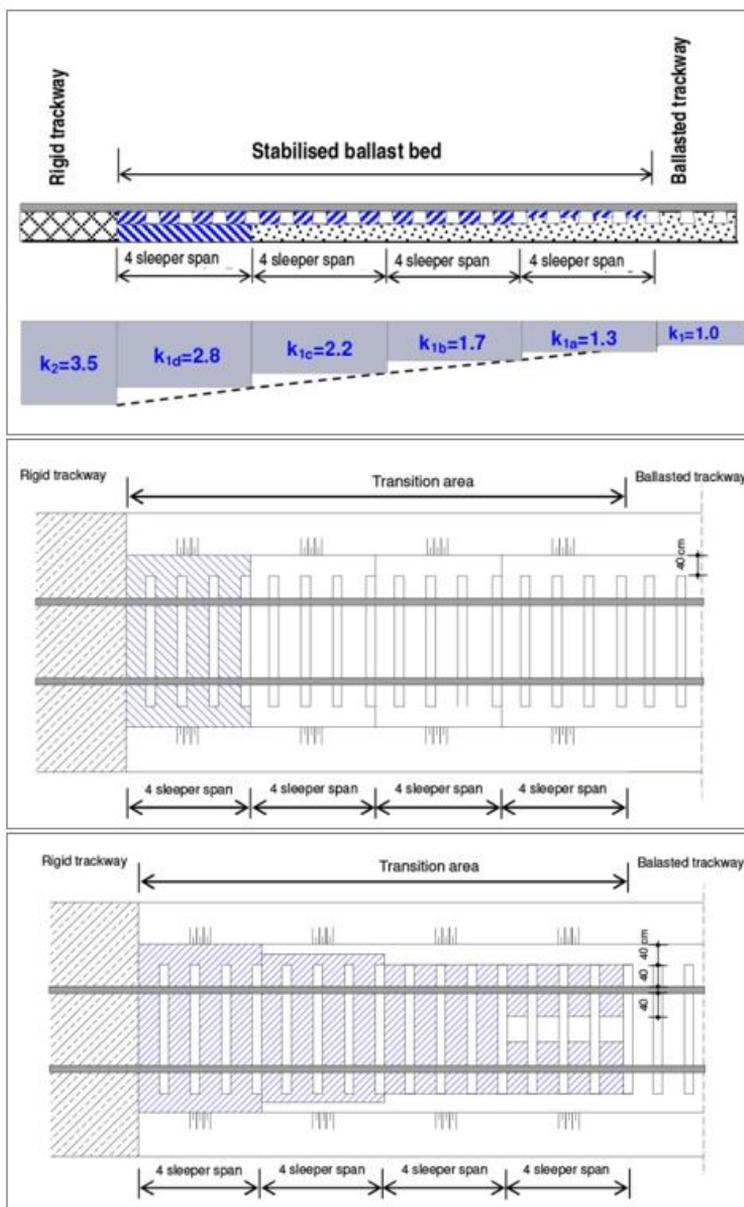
Esquema de aplicación del encolado de balasto en zonas de transición,(FUENTE: Track stability using ballast bonding method (Stjepan Lakusic) [14])
